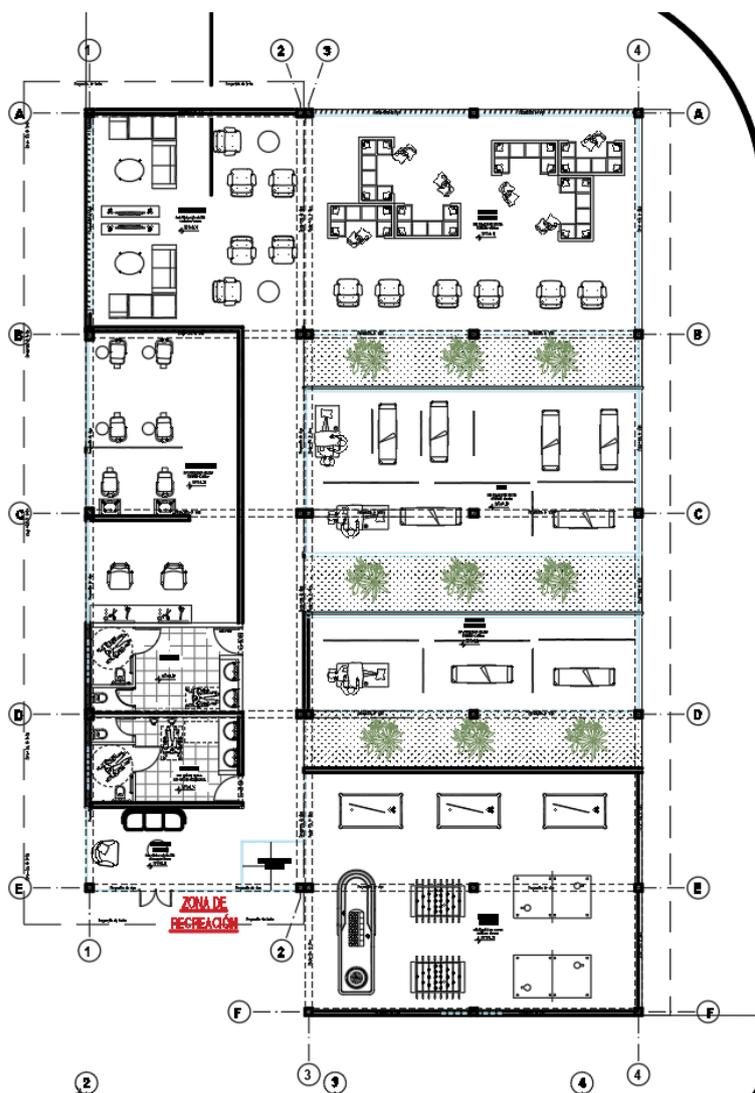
Distribución arquitectónica en planta del 1° piso, “Zona de Recreación”
